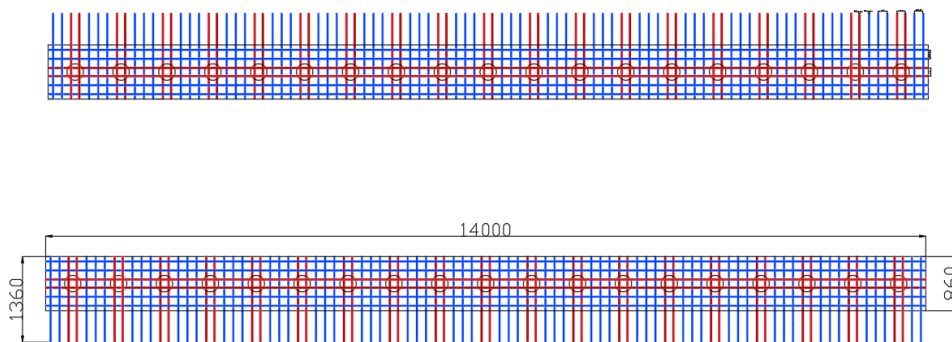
Armaduras completas de la Pila 2 Lado corto
